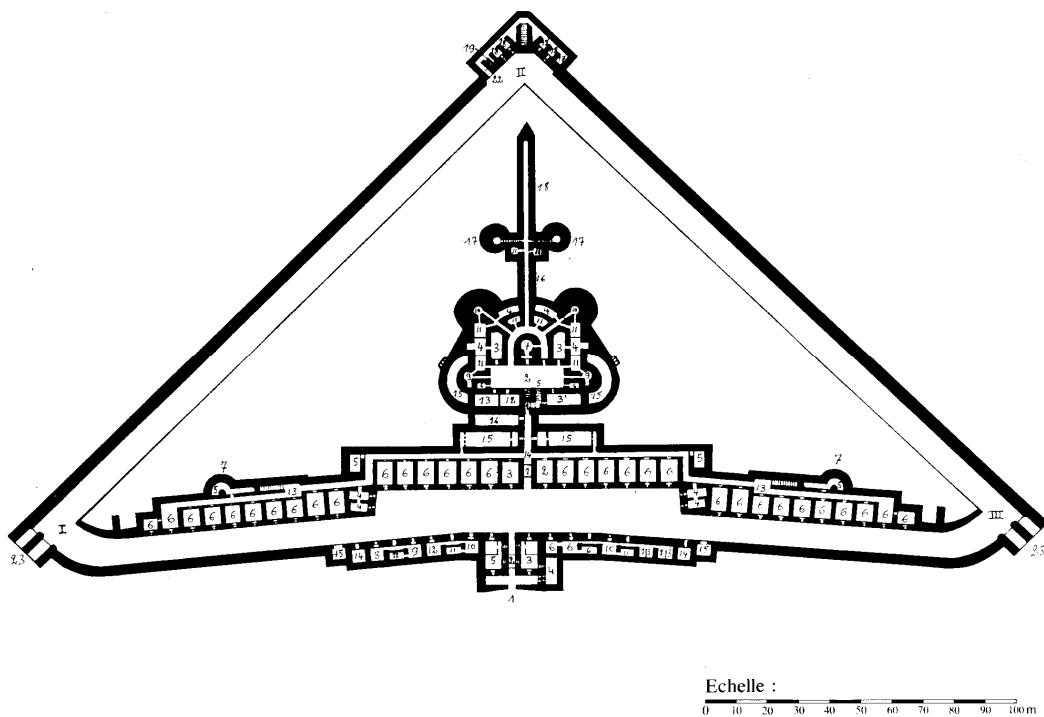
Plan du fort de Barchon à sa construction⁵²
